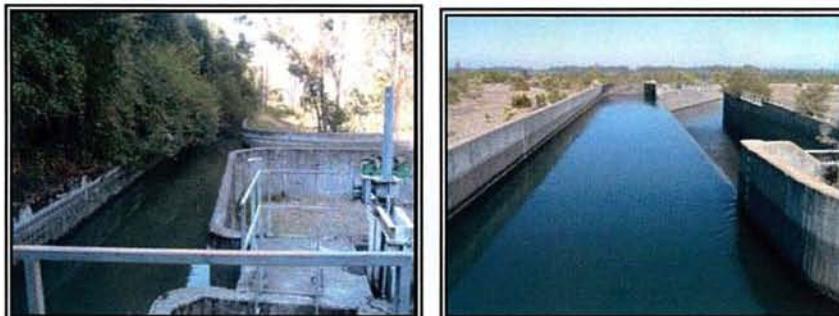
Salida sifón Río Maule, lado norte y Duao-Zapata.
